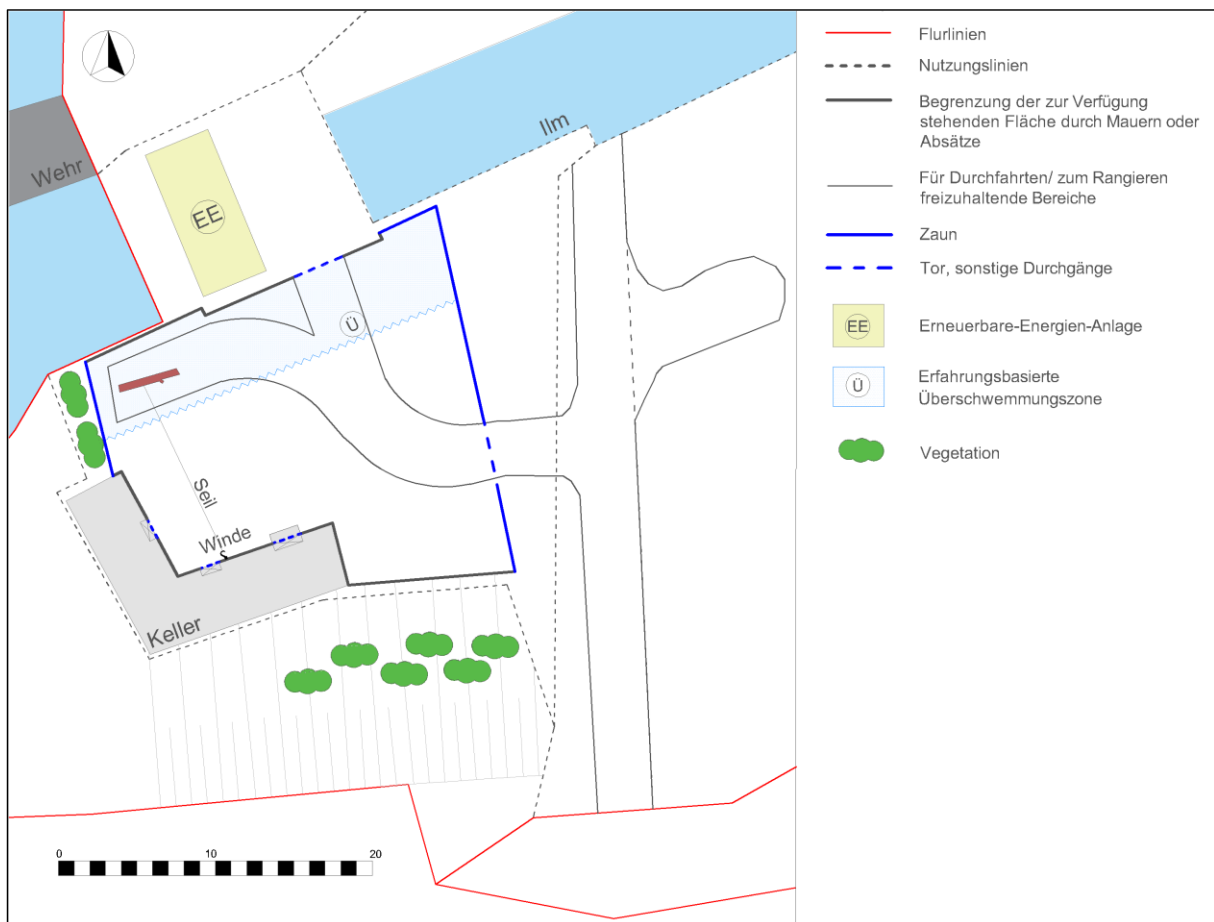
Lageplan der Kleinwasserkraftanlage Oberroßla
